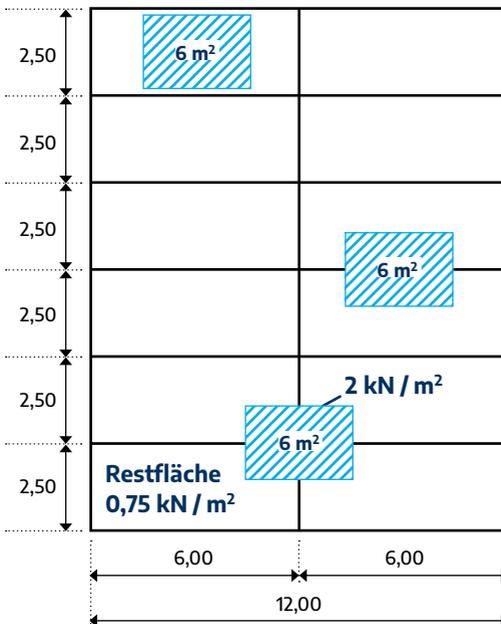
Beschränkung der Belastungsflächen bei Raumgerüsten
